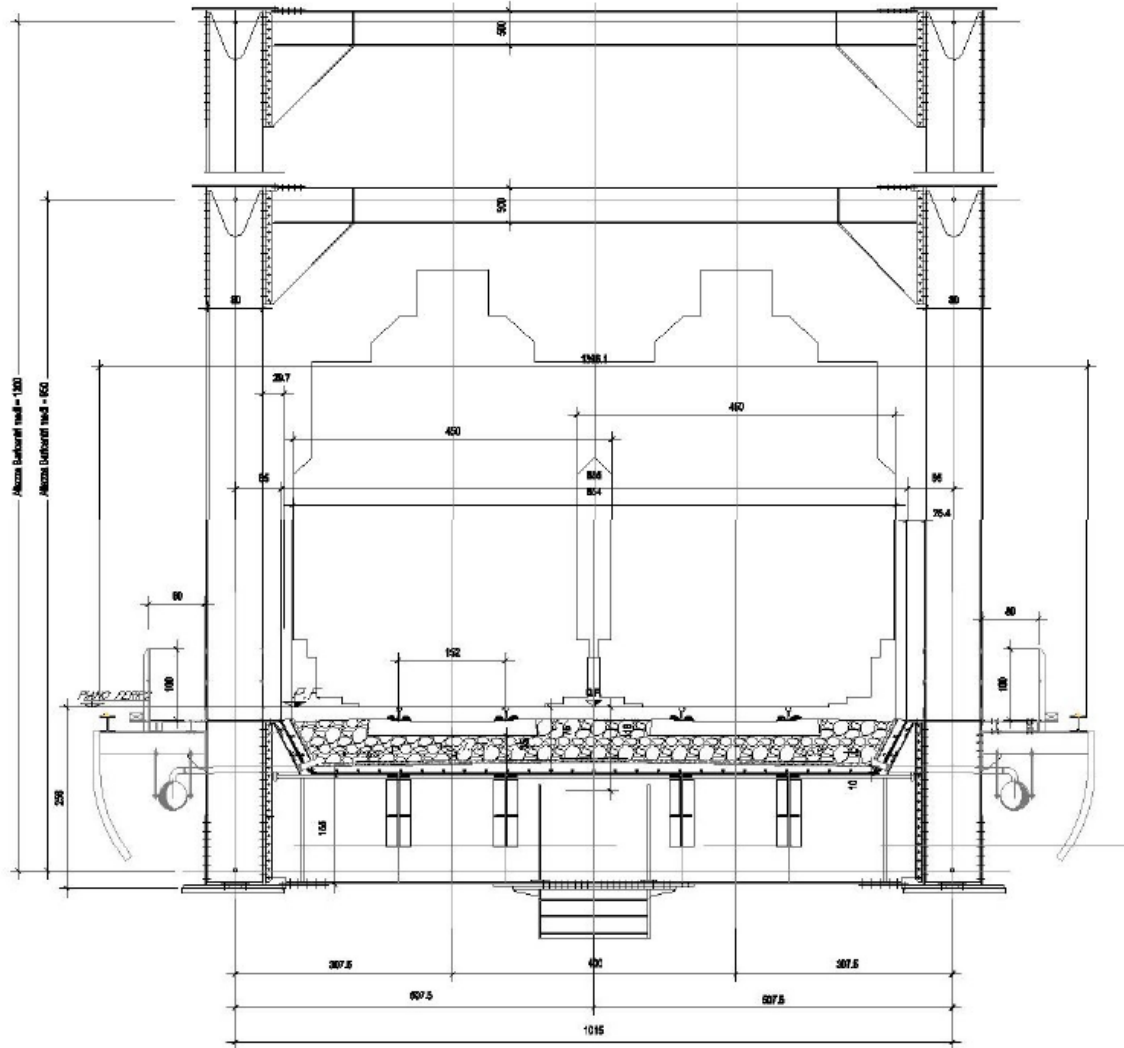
Sezione trasversale impalcato in acciaio da L=70m
